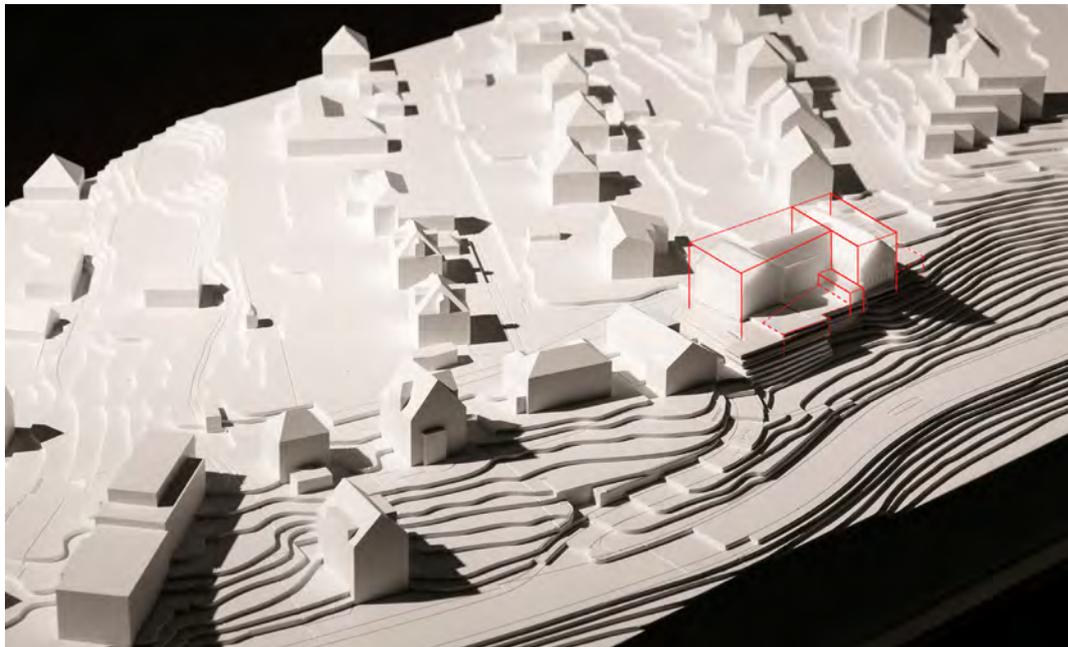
Modellfoto Machbarkeitsstudie Ansicht von Südosten mit Baubereichen gemäss Gestaltungsplan
